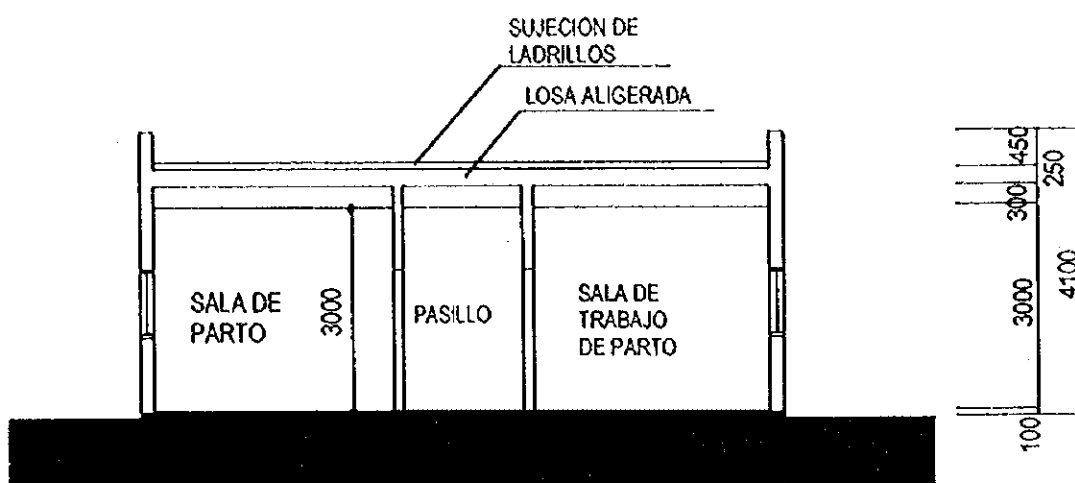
Plano de sección del pabellón obstétrico del C.S. Piedra Liza
